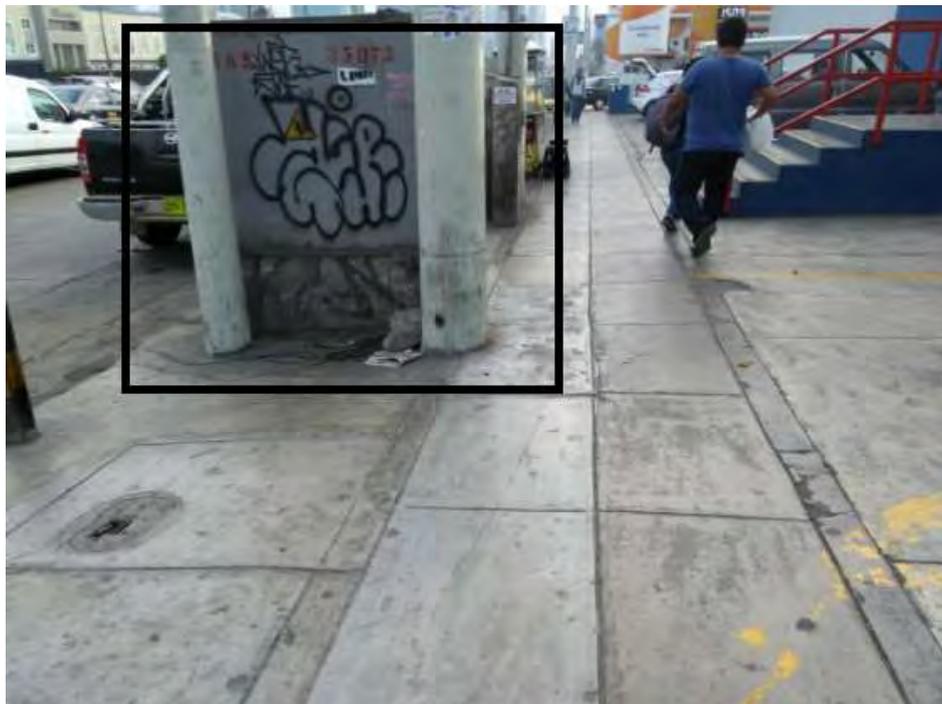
GRIETAS EN VEREDAS
